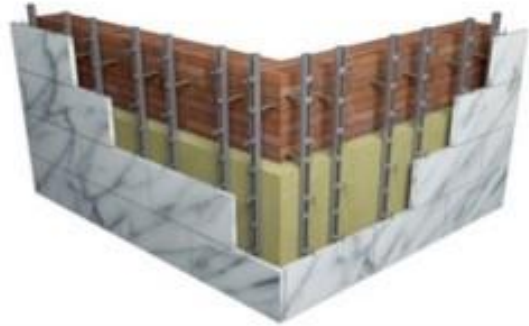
Варіанти поетапного монтажу вентильованого фасаду
